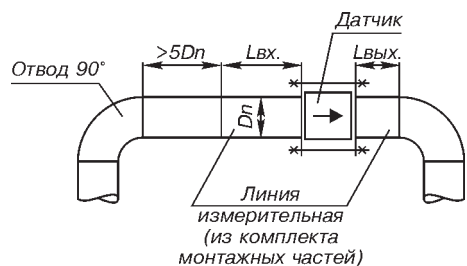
Установка в газопровод (паропровод) с отводом 90°.
